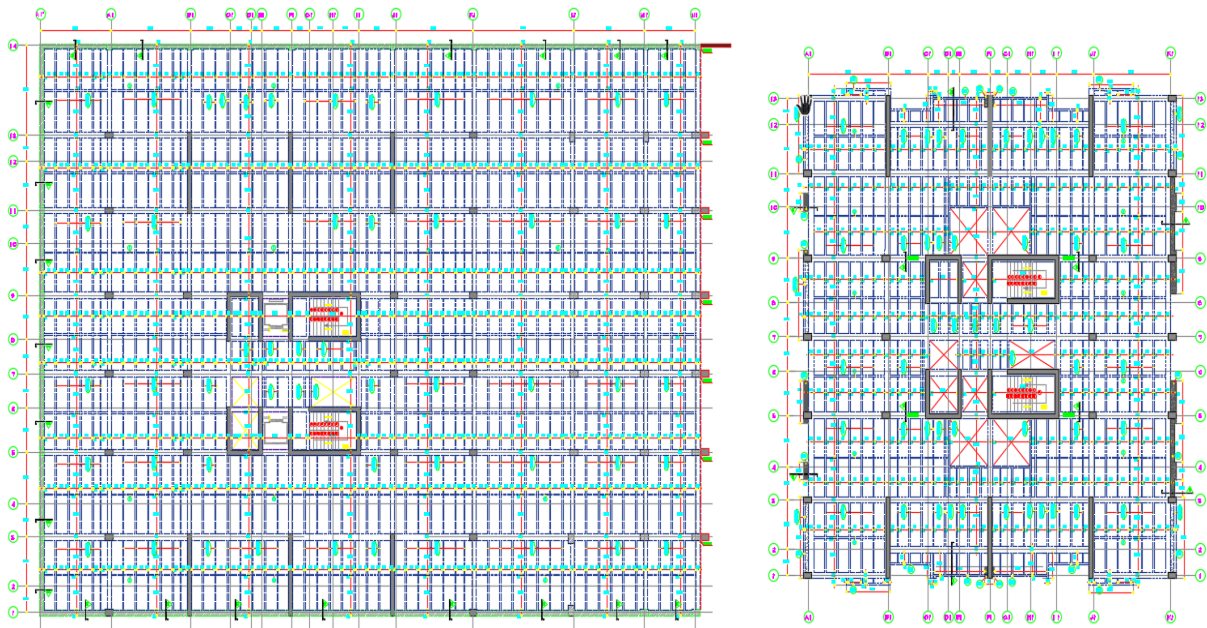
y 3. plano losa sótano y losa piso tipo (planta).
